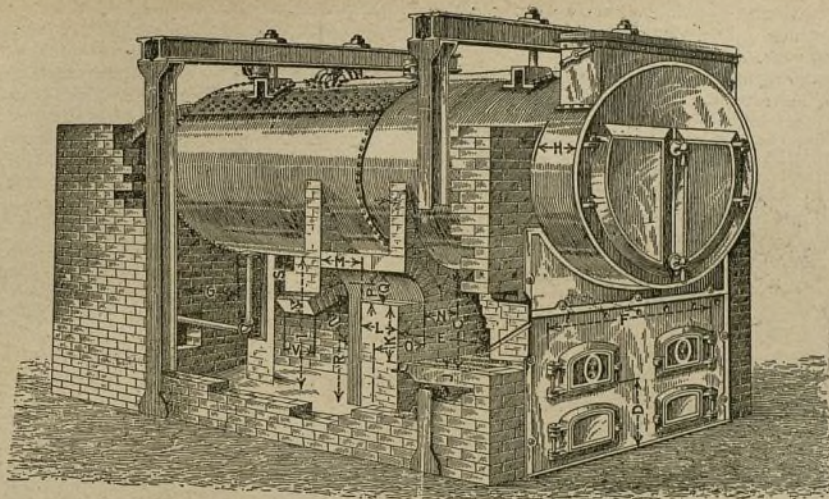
Nuevo sistema de montura recomendado para calderas horizontales de tubos de retorno.
